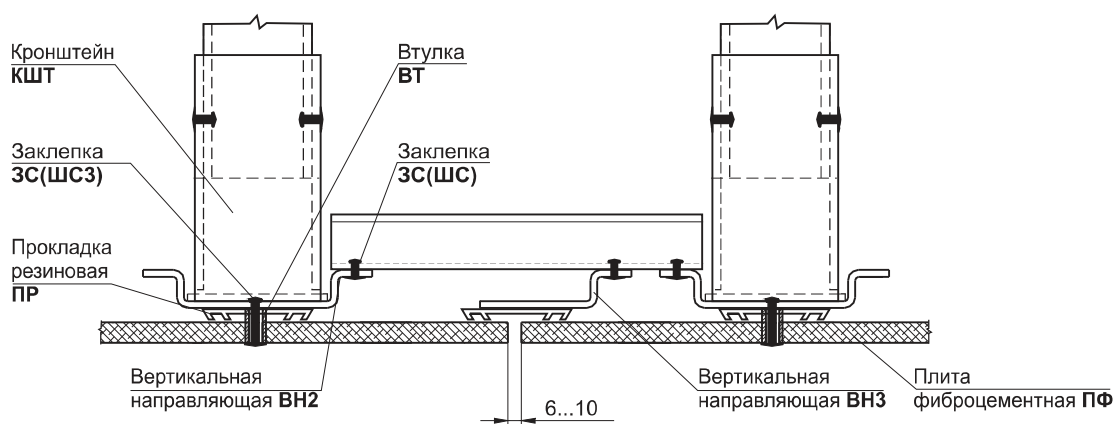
Узел вертикального открытого шва крепления фиброцементных панелей (горизонтальная раскладка).
